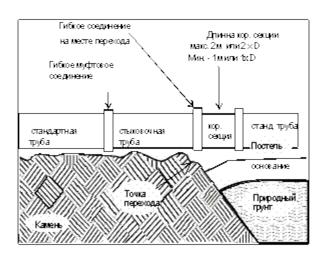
Прокладка трубопровода на переходе скала-грунт
